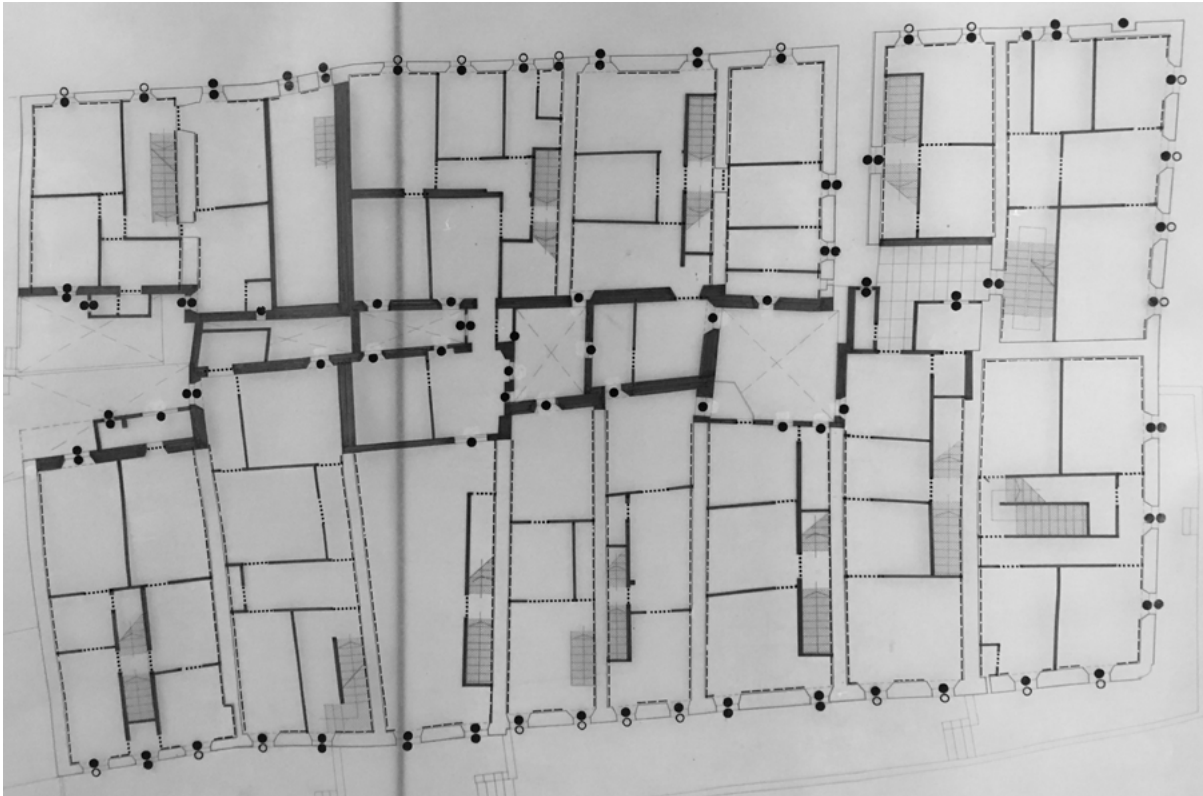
Ancona, Rione di Capodimonte, progetto di risanamento e ristrutturazione del centro storico, pianta del piano terra, 1976, nella quale si indicano le murature da demolire (campiture nere), gli intonaci da spicconare (linea tratteggiata), le porte da demolire (linea puntinata), i serramenti da rimuovere (cerchio nero) e quelli da recuperare (cerchio). APIUAV, Trincanato 3, Attività professionale, 1, 062, 5.
